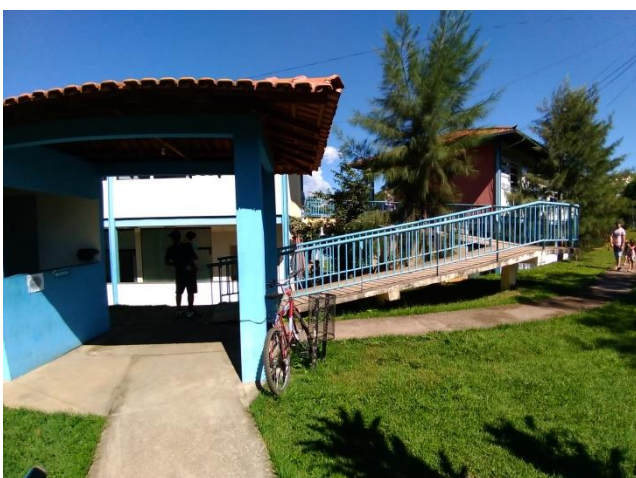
Vista da rampa 2, de acesso ao 2º Pavimento.
